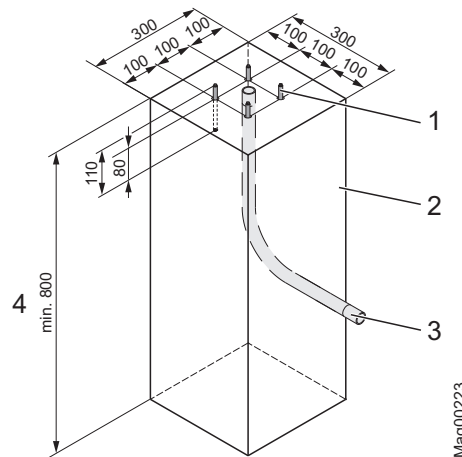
Fundamentschema stöd Stolpe och fotocells stolpe (mått i mm)
